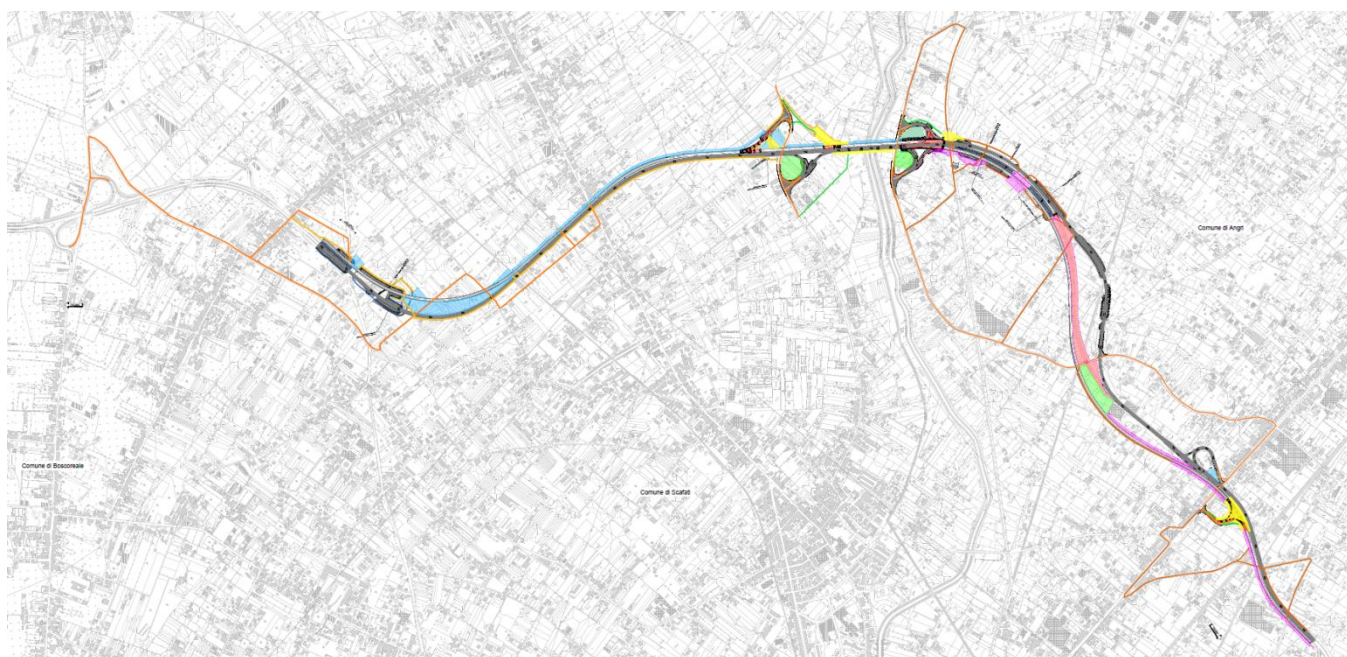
Planimetria attività di cantiere Lotto 2 – Fase 3
